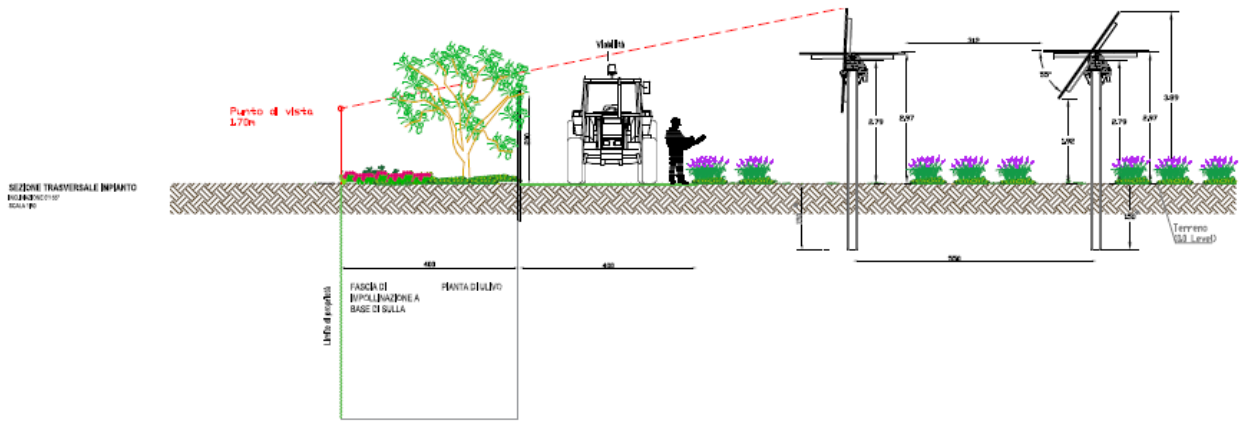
Sezione tipo della soluzione adottata con tracker alto (altezza in corrispondenza dell'asse di rotazione pari a circa 280 cm) ed interasse di 5,5 m
